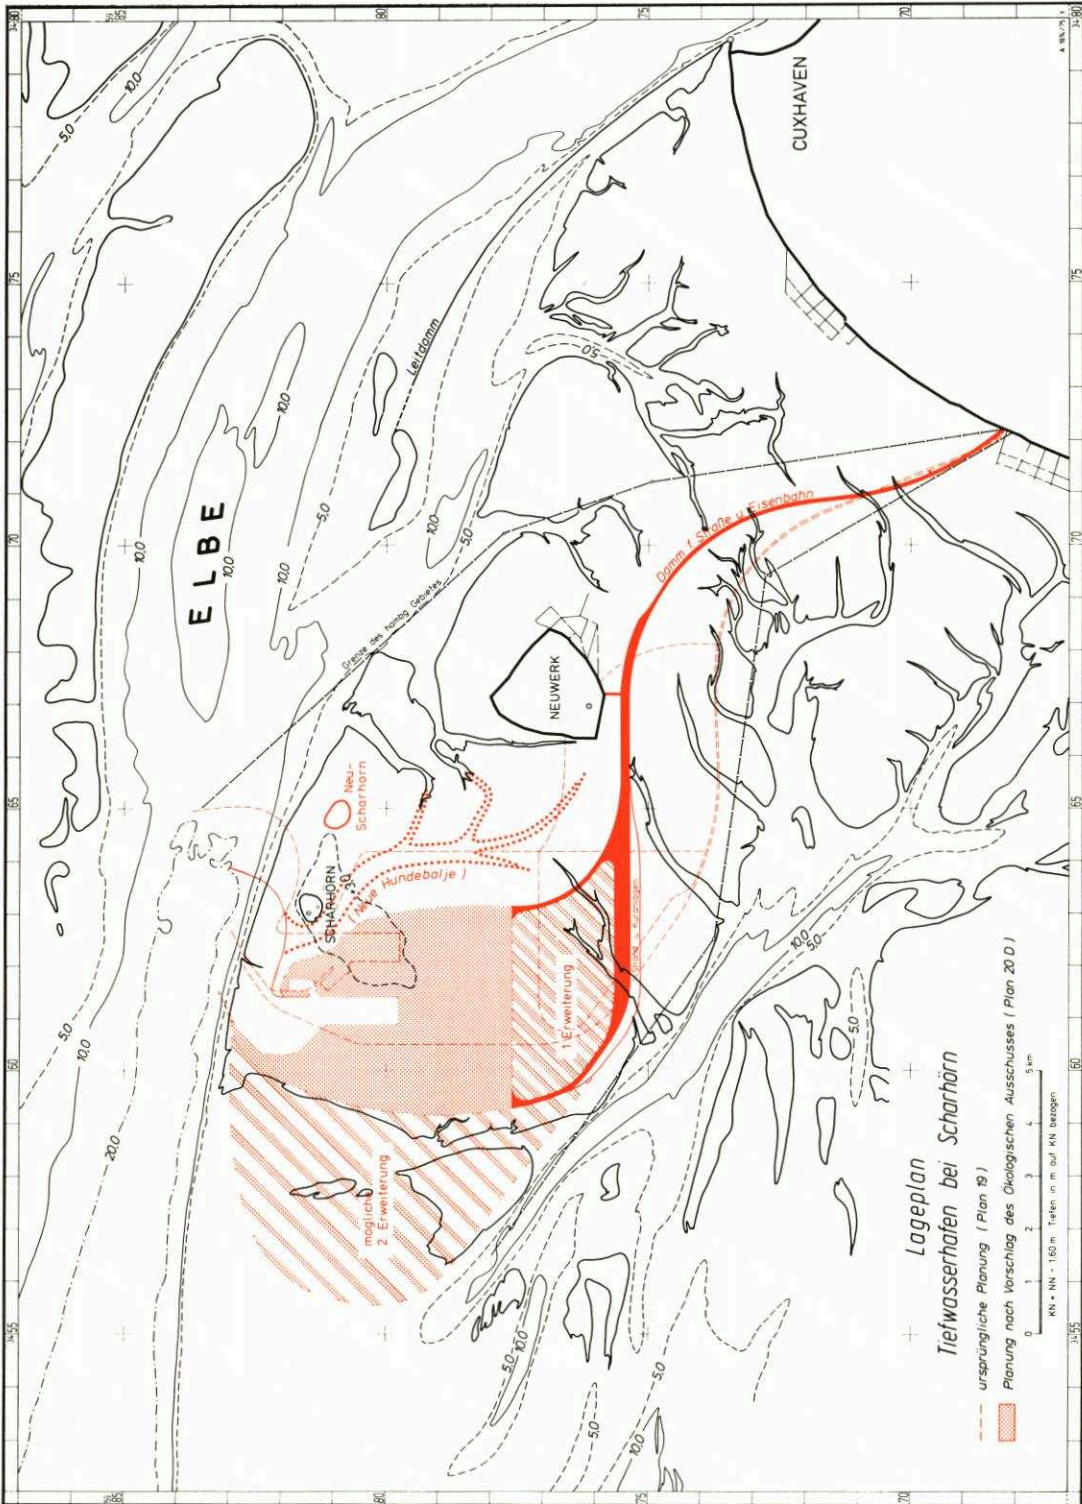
Neuerwer Watt mit vorgesehenem Tiefwasserhafen und Damstrassen nach Plan 20 D (ausgezogen) und ehemaligem Plan 19 (gestrichelt)
